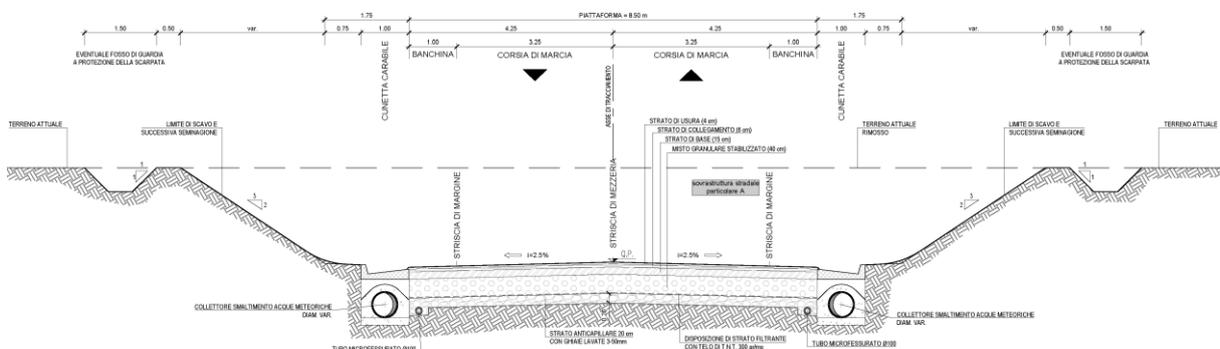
Svincolo di Baiano sezione tipo rampa bidirezionale in trincea
